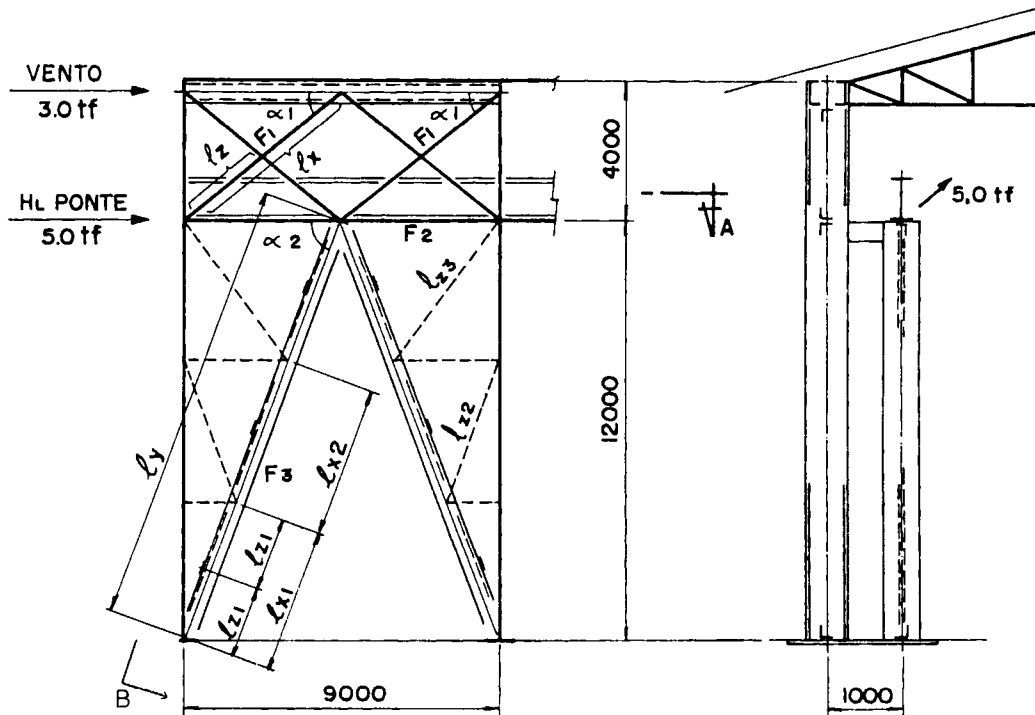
a - Esquema para cálculo do contraventamento vertical
